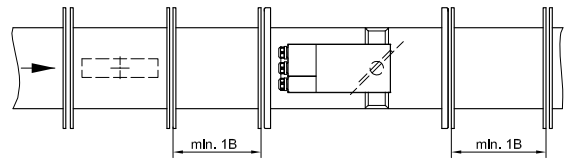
Einbau nach Störstelle, z.B. Brandschutzklappe
